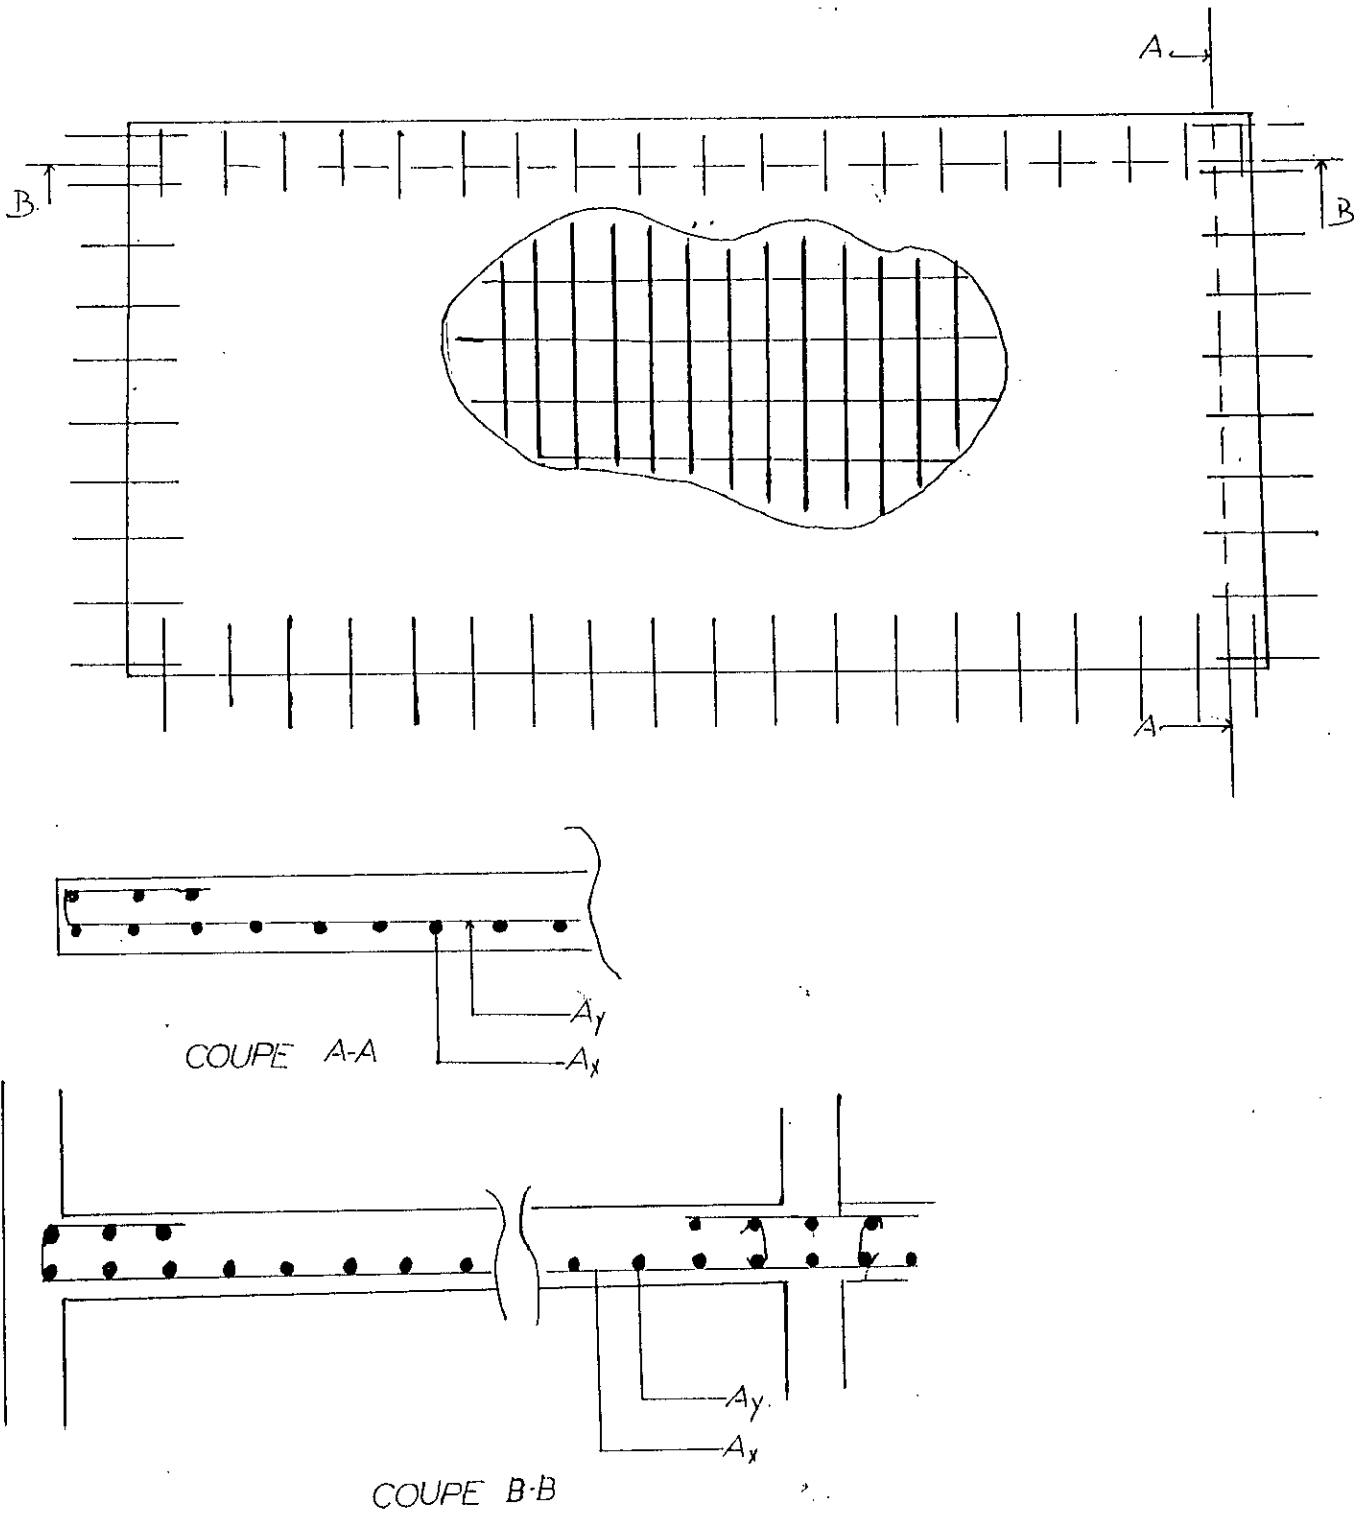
FERRAILLAGE D'UNE DALLE DE RIVE D'UN ETAGE COURANT
